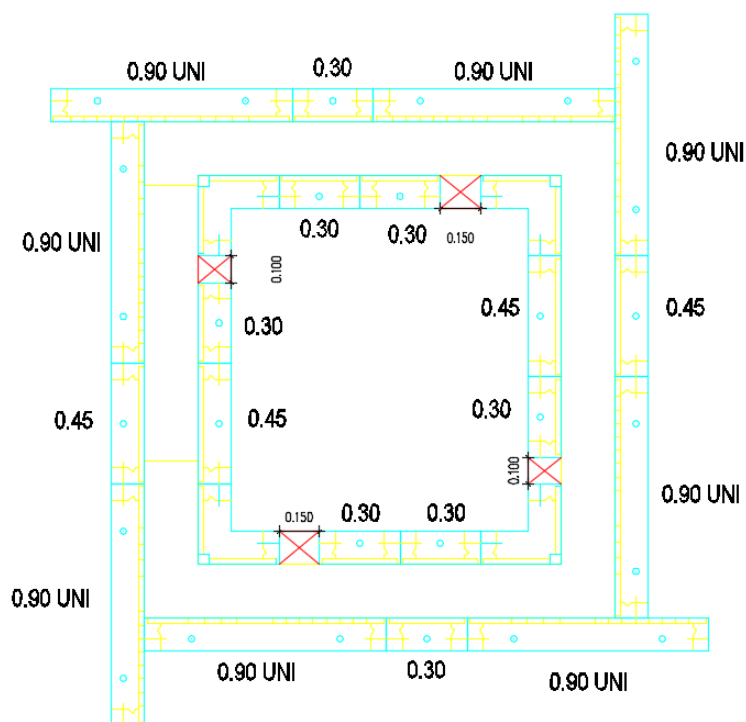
Disposição dos painéis para a execução da caixa do elevador
